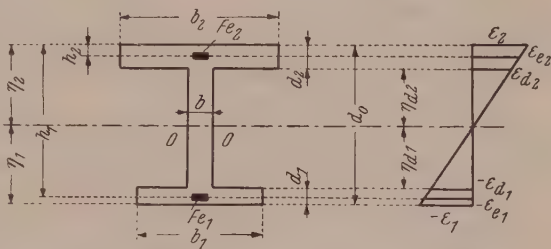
Doppelt bewehrter Stahlbetonquerschnitt.
